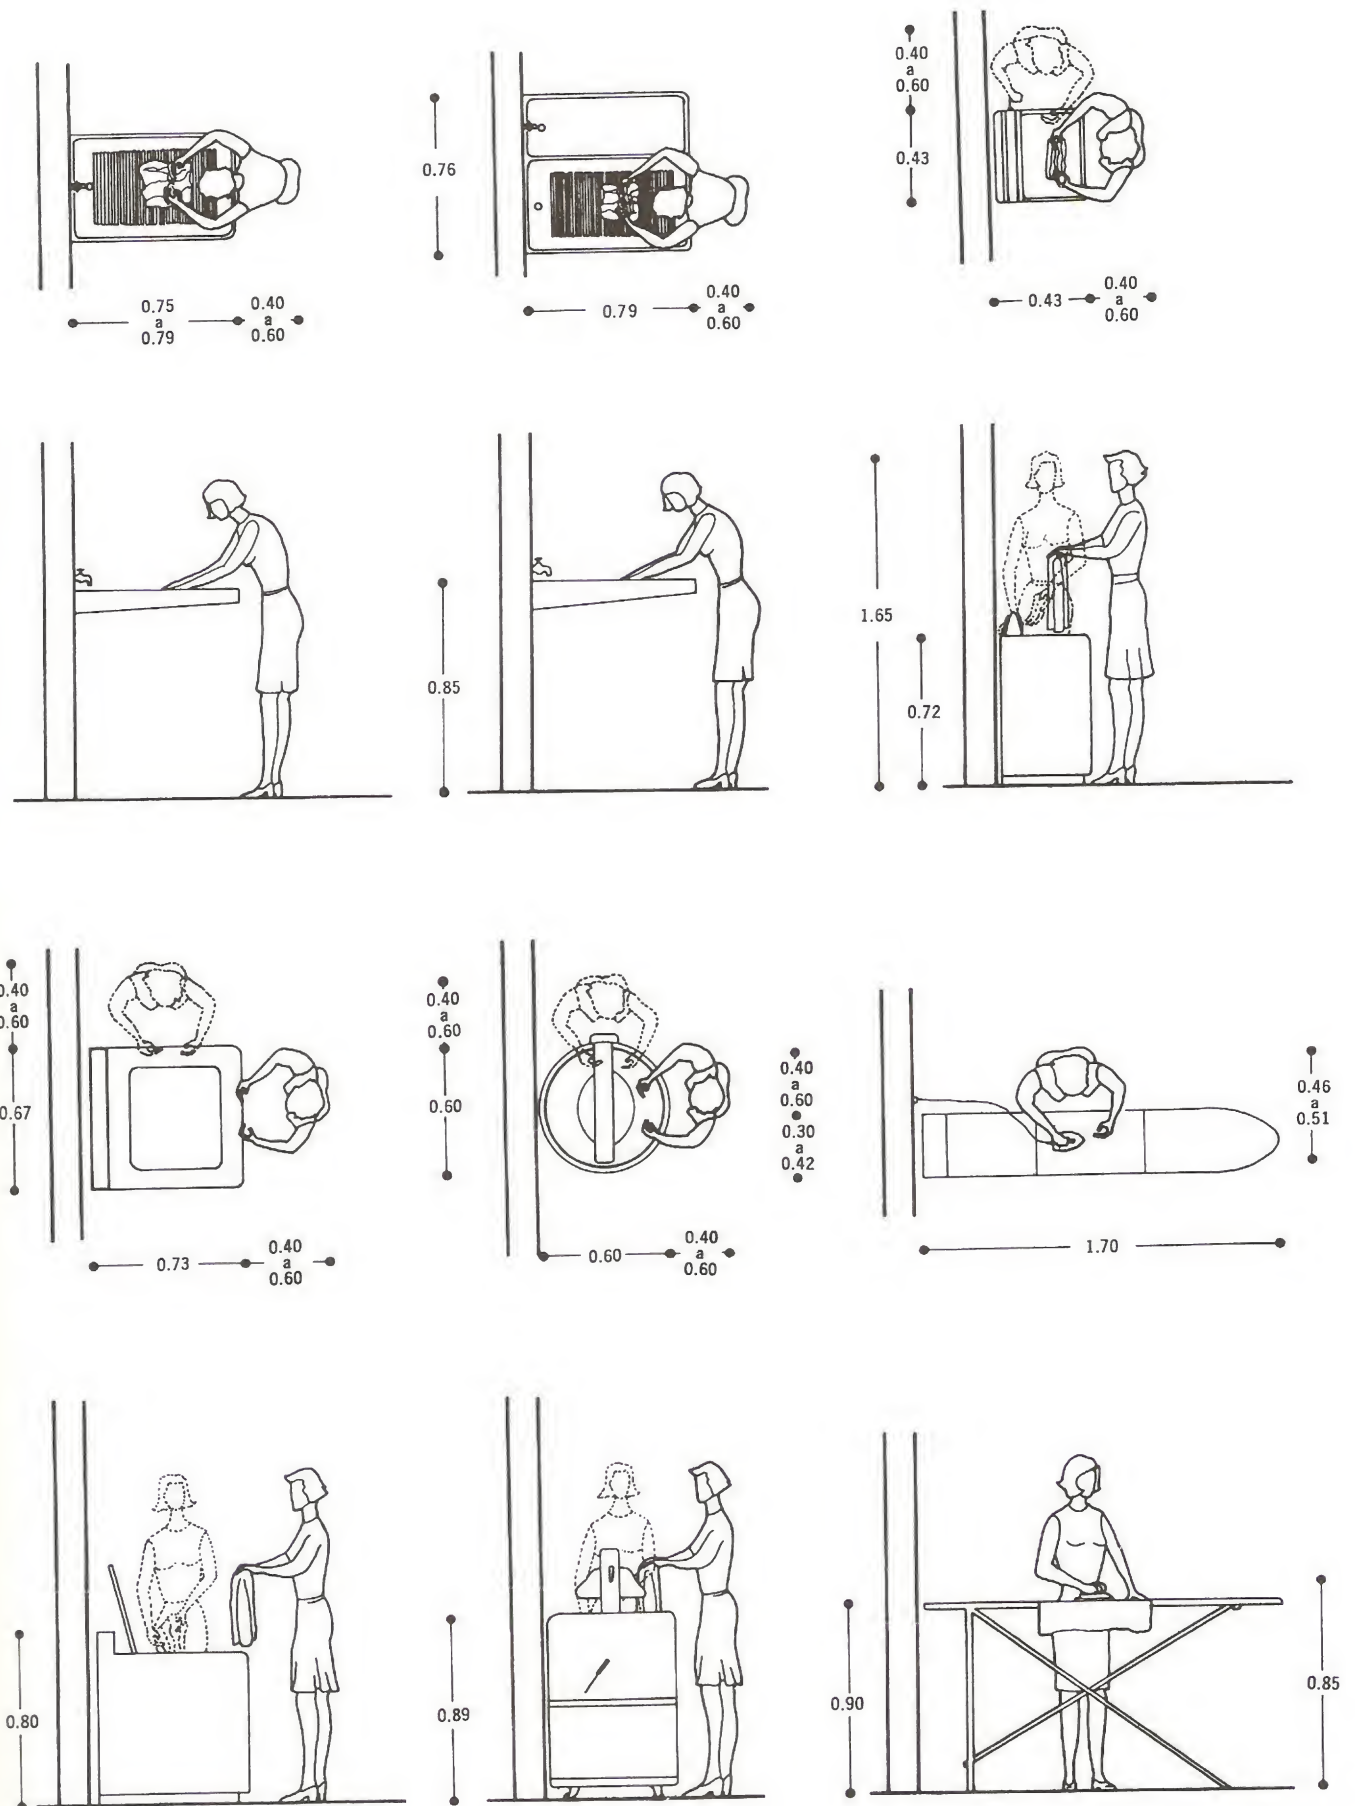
Espacios para el lavado, secado y planchado de la ropa.
